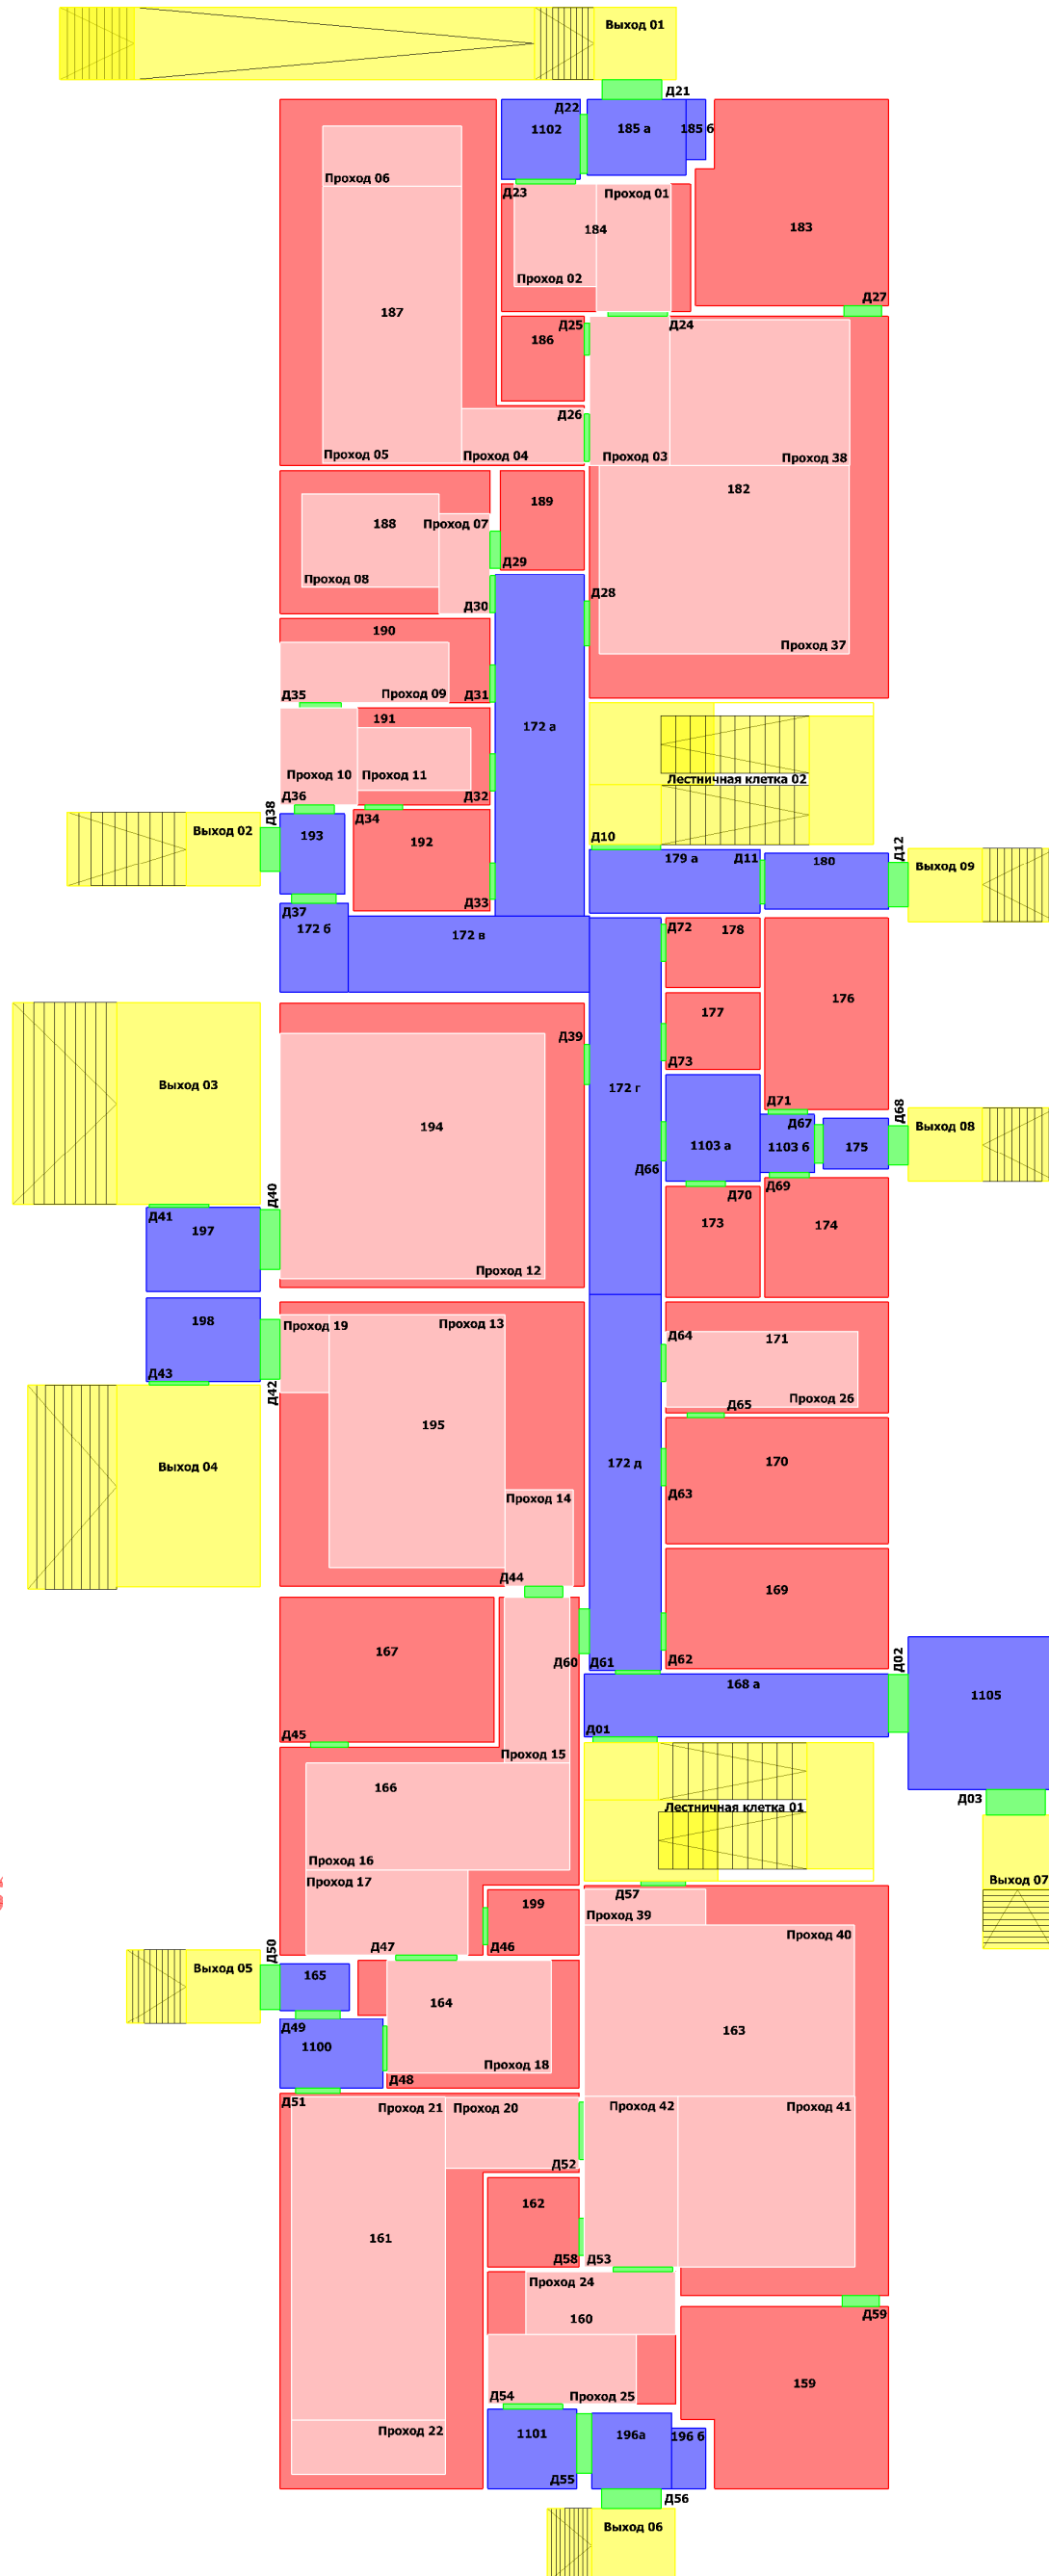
Топология 1-го этажа здания Детского сада на 60 мест с начальной школой на 100 учащихся
